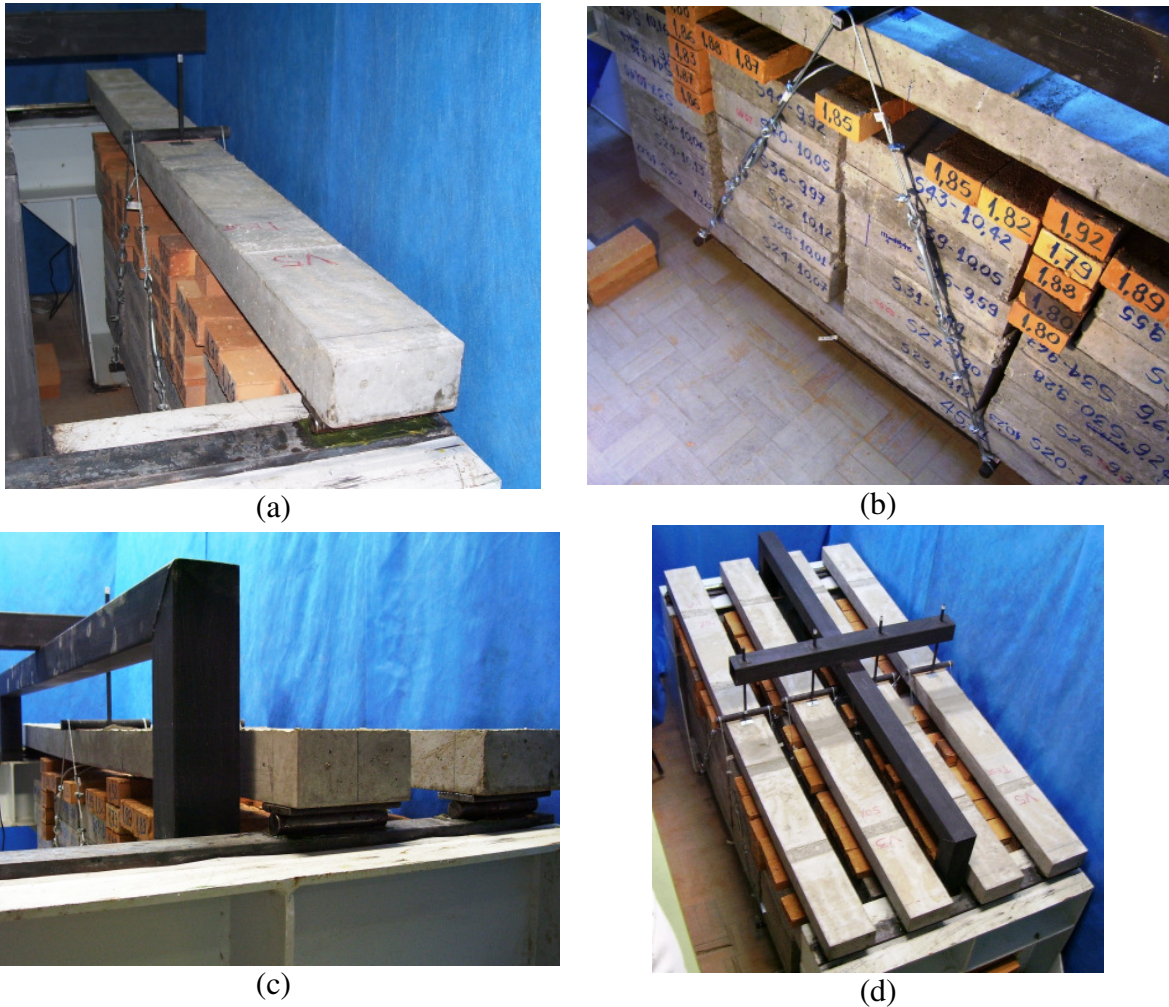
(a) viga V5, (b) viga V2, (c) vigas V5 e V2, (d) vigas V5, V2, V3 e V4.
